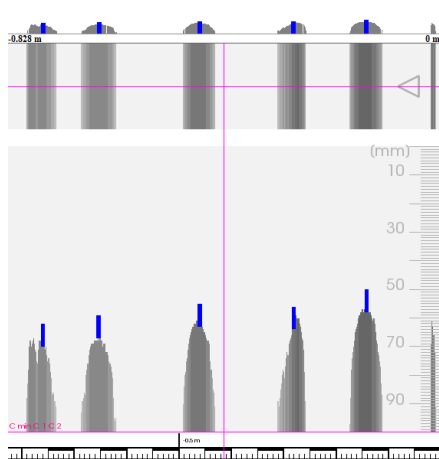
Poutre Pt03 – Travée 3 côté P2
